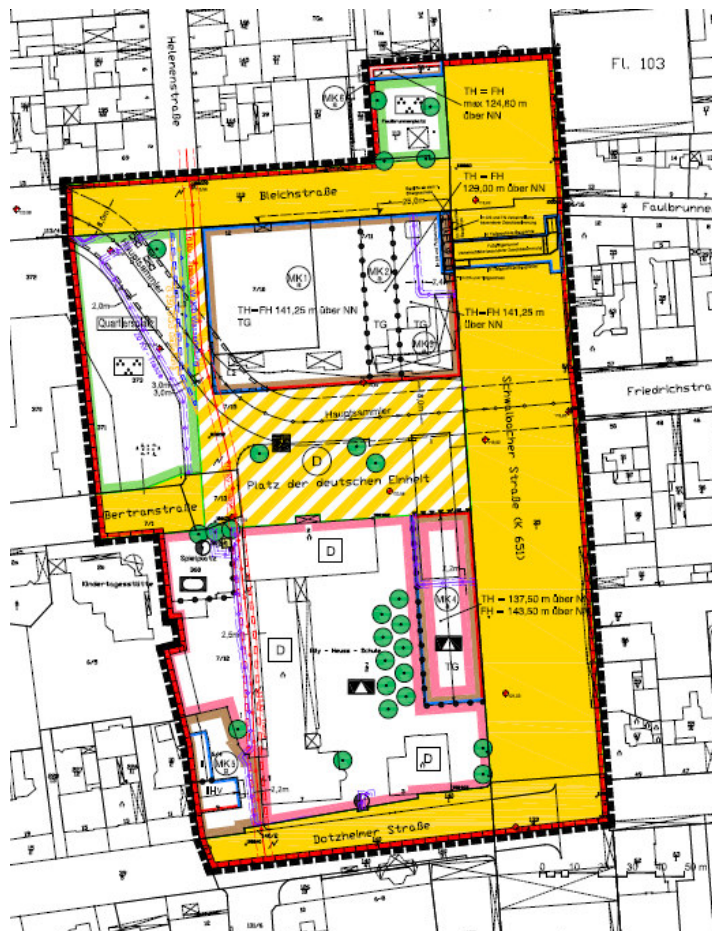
Planarstellung des Bebauungsplans „Platz der Deutschen Einheit“ 2011/01. Quelle: Stadtplanungsamt (2011).
